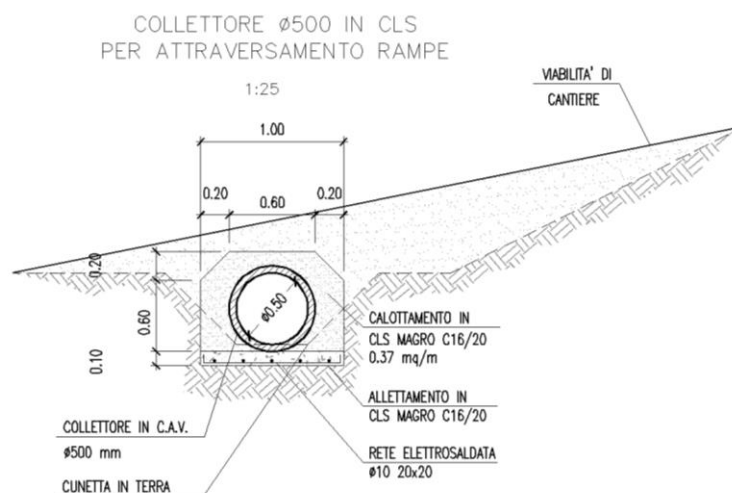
COLLETTORE D500 MM PER ATTRAVERSAMENTO PISTE DI CANTIERE
